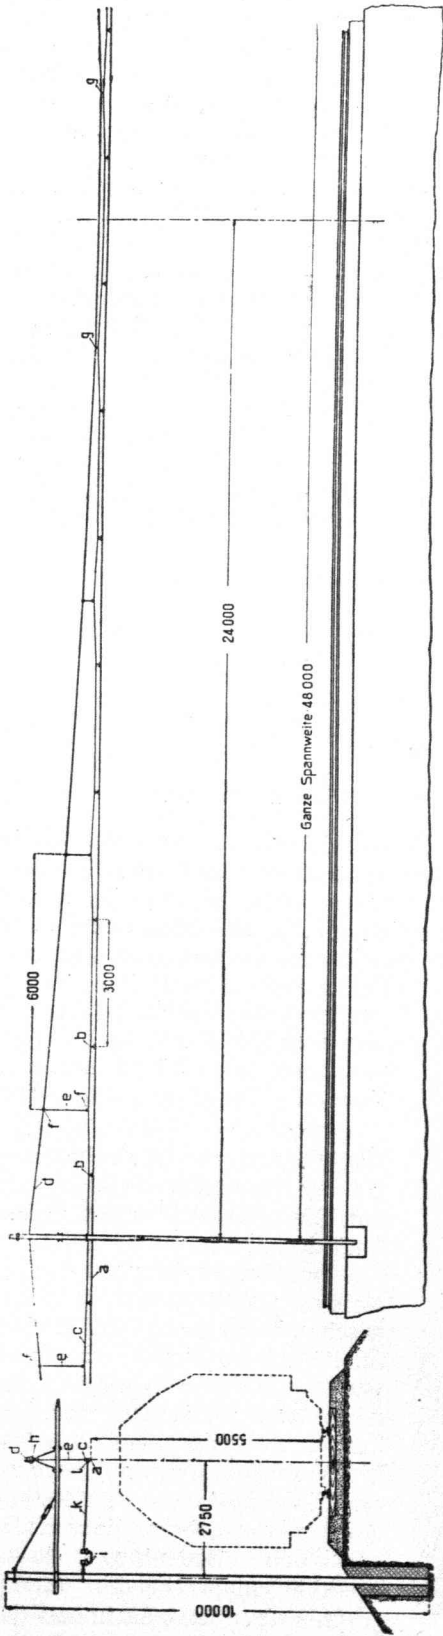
Schema der Vielfachaufhängung auf gerader Strecke, System Siemens-Schuckert.
